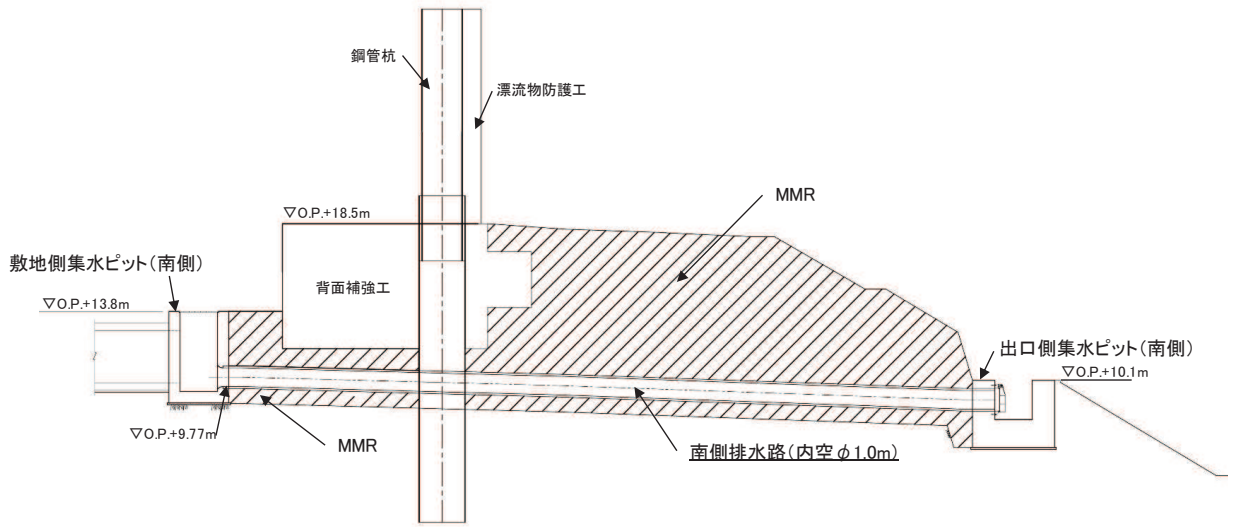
(2) 南側排水路配置図 (縦断図, 1-1' 断面)
